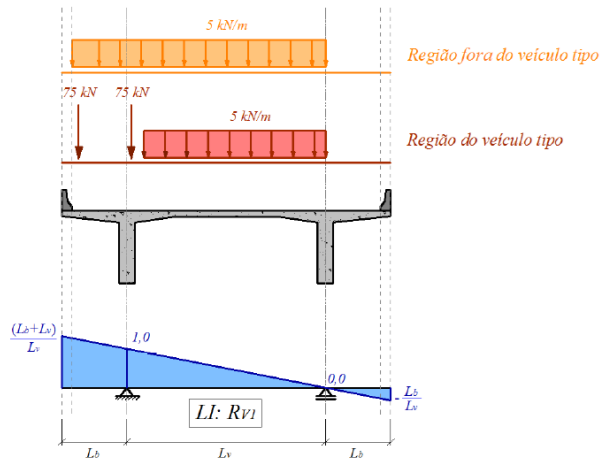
Corte transversal das cargas móveis em uma ponte de duas vigas
